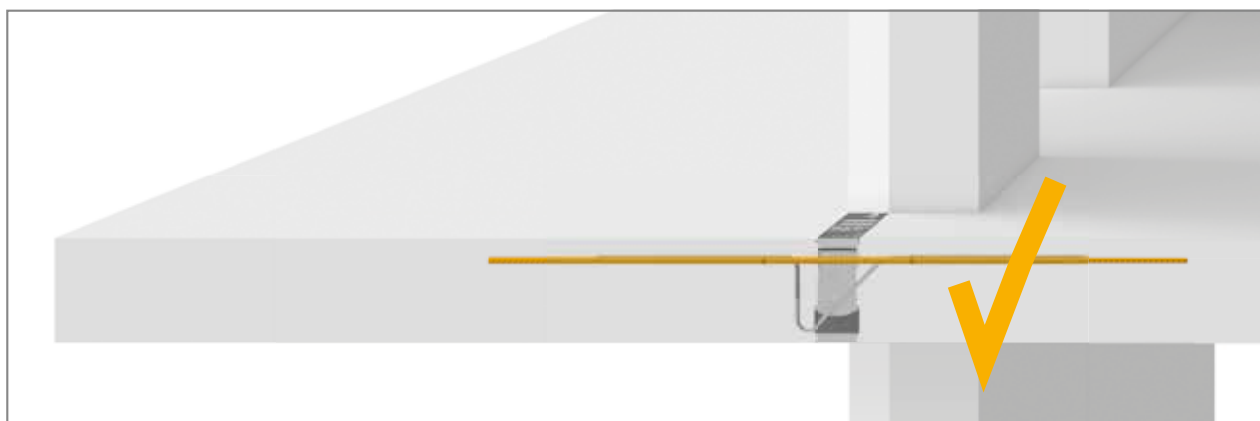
Schöck Isokorb® tipo K, se montato correttamente la barra tesa sta sopra
